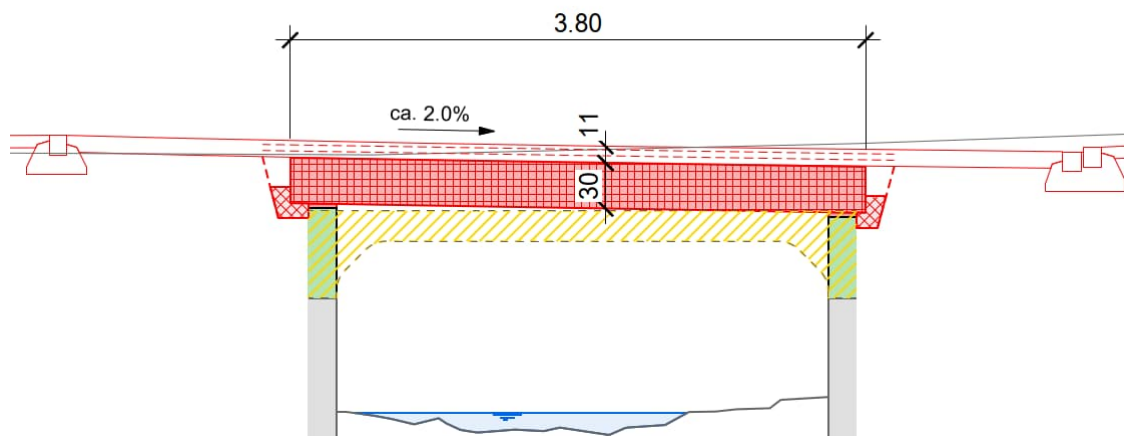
Ersatz Brückenplatten, Einlenker Moosstrasse (vgl. Plan Nr. 2-1537.1 / 05)
